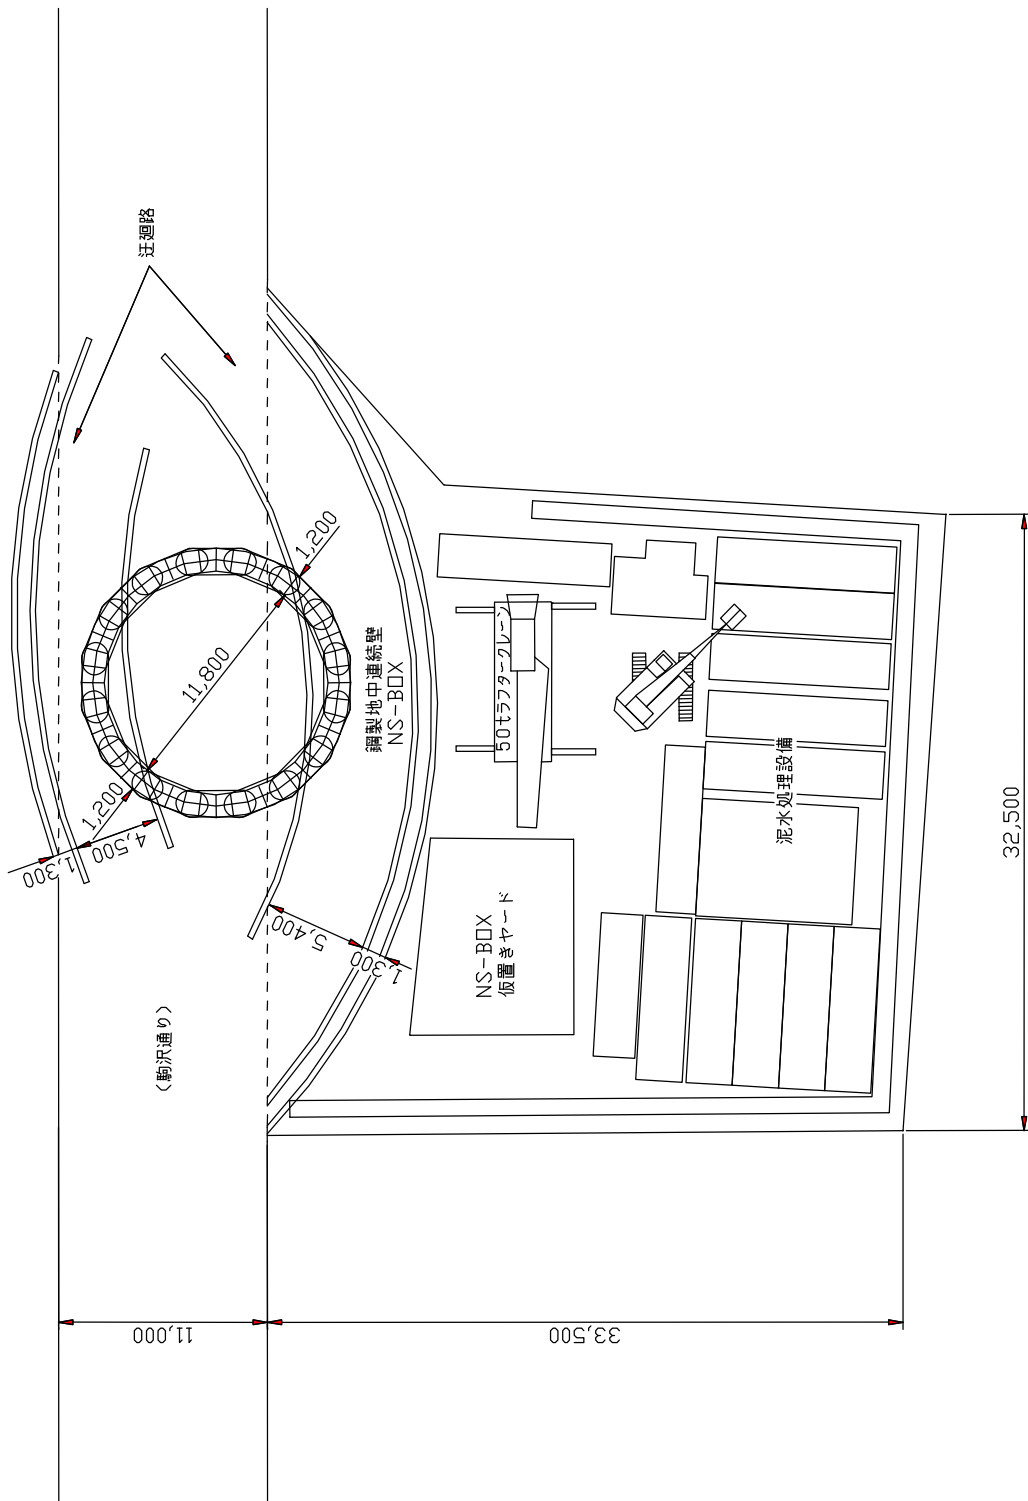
は東京都下水道局新駒沢幹線立坑工事の施工ヤード平面図である。本工事では道路の一部および近隣の敷地に施工ヤードを設けて施工を行った。図-参7.1の例よりも立坑規模は大きいにもかかわらず、ヤード面積は1450m<sup>2</sup>と縮小することができた。
